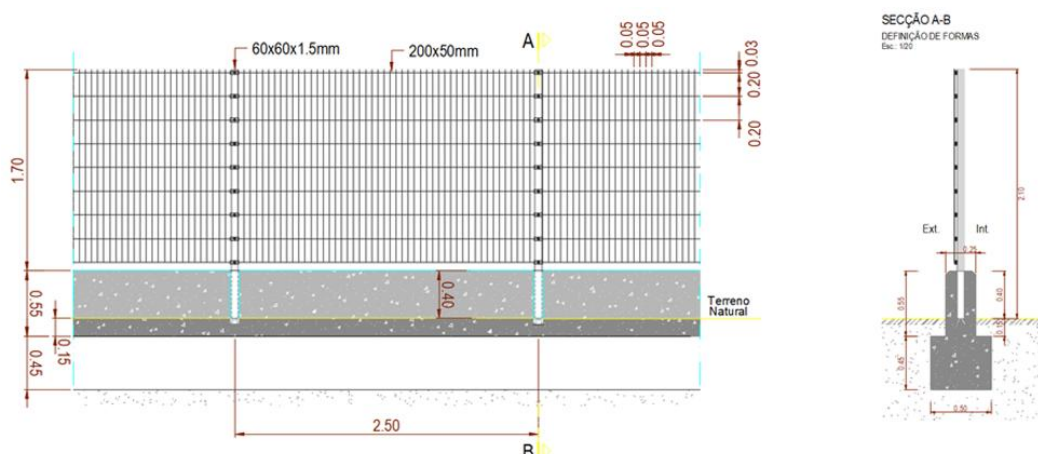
Alçado e corte tipo para vedação em Estações e Apeadeiros
